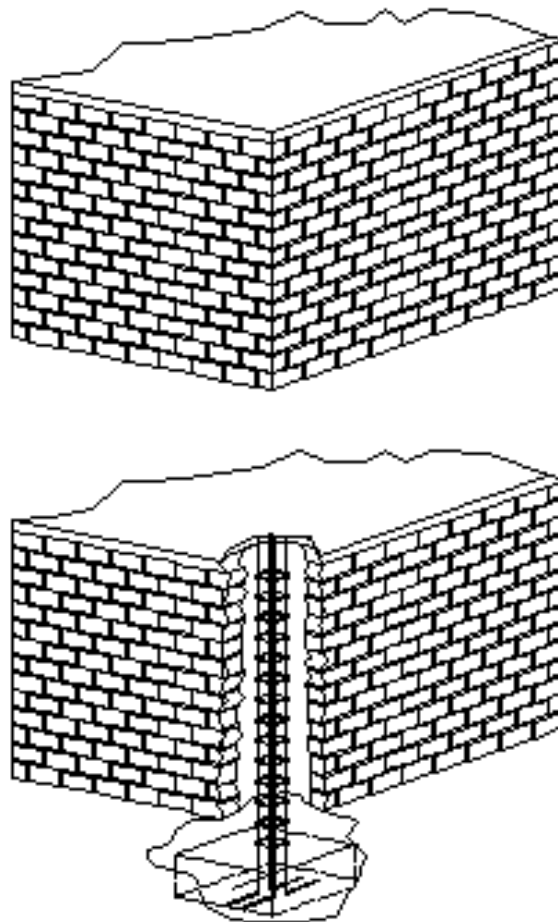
Detalle de inclusión de columnas de reforzamiento en muro sin confinamiento existente.
